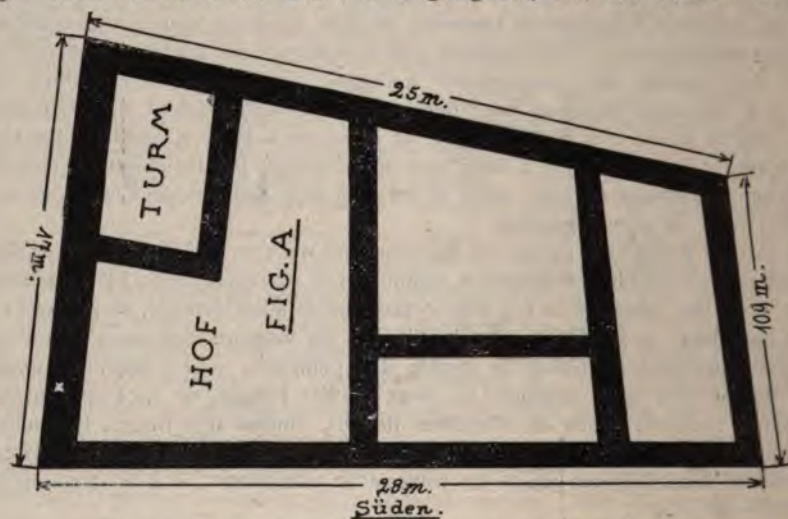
Rekonstruierter Grundriss der Burg Chestlatsch.
